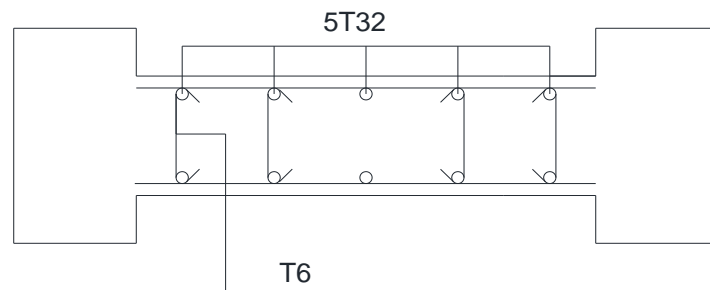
Schéma de ferrailage du voile (poutres noyées - plancher au dalles pleines)
